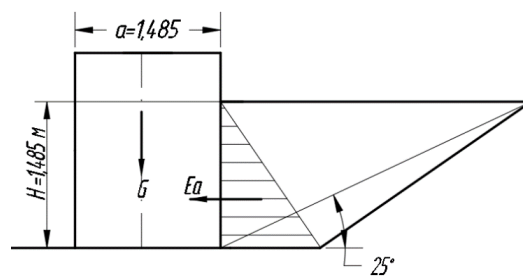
Эпюра бокового давления грунта на сборную бетонную стену
